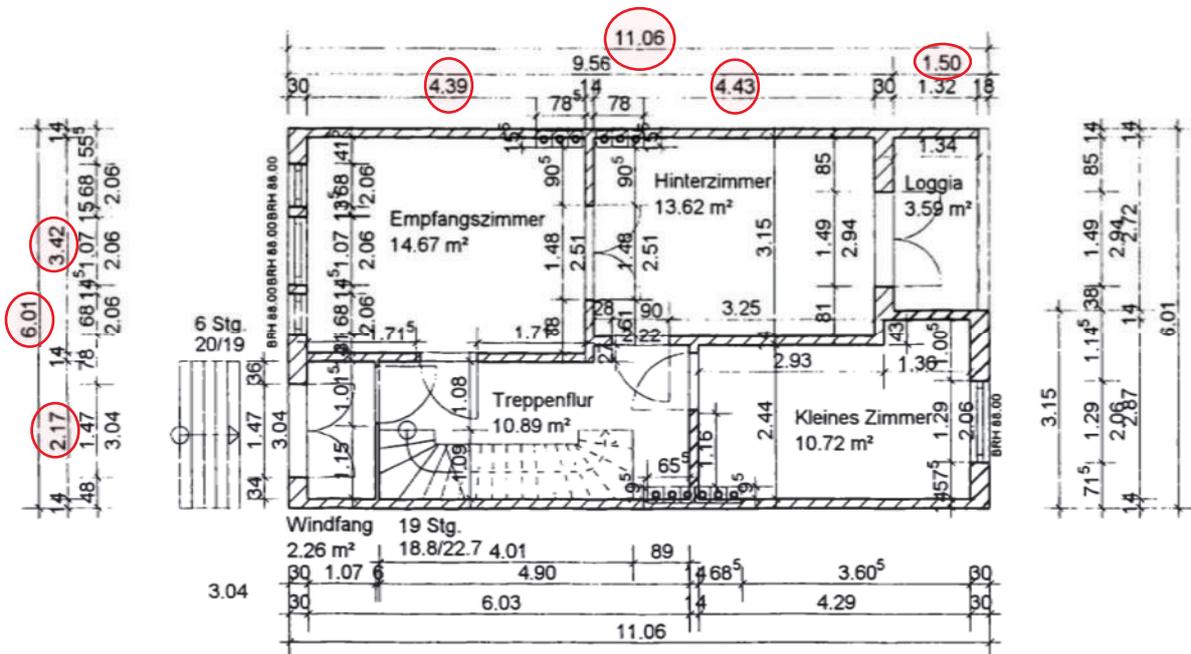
Breite und Tiefe des Bremer Reihenhauses - Grundriss Hochparterre (Scharla 2003:110)
